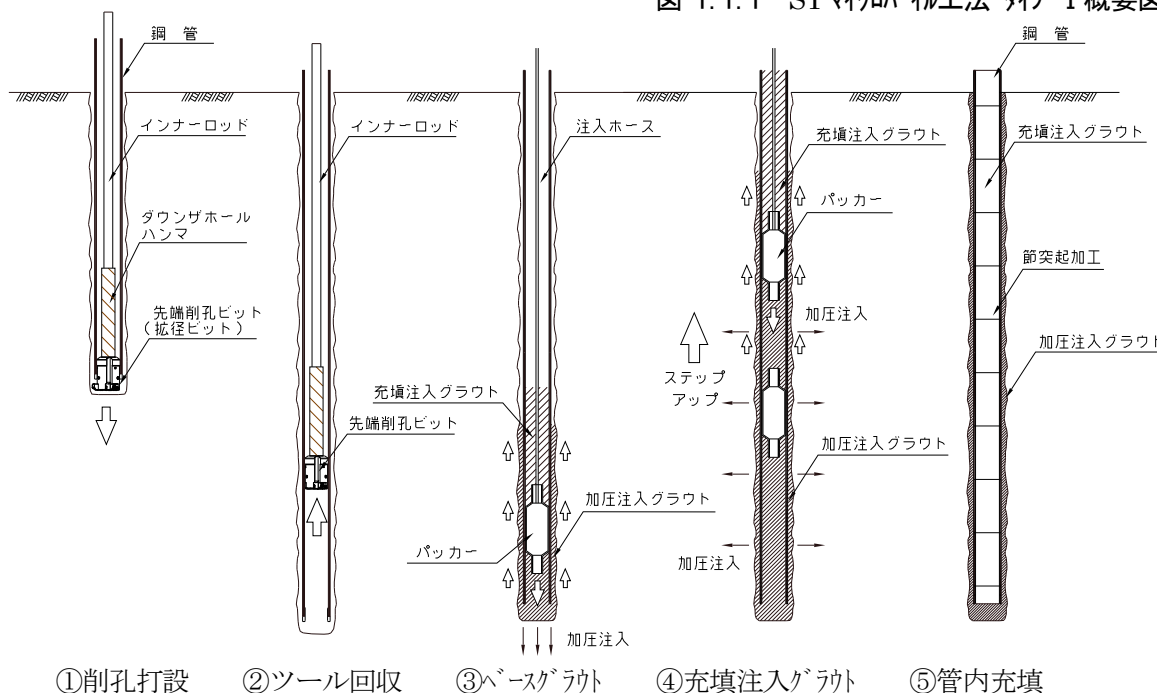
ST マイクロパイル工法タイプ I の施工手順（回転打撃；D.T.H方式）
